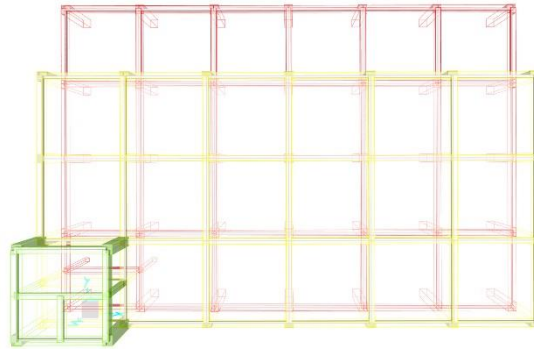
Denah Model Struktur Rumah Sakit L2
